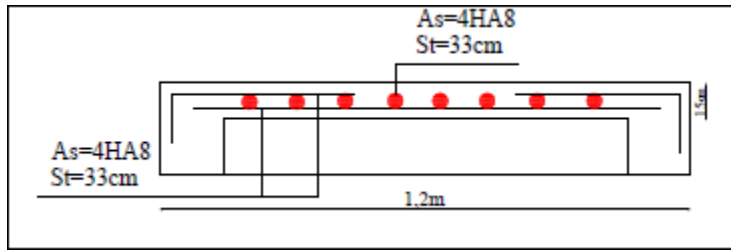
Schéma de ferrailage de la dalle pleine local machinerie
